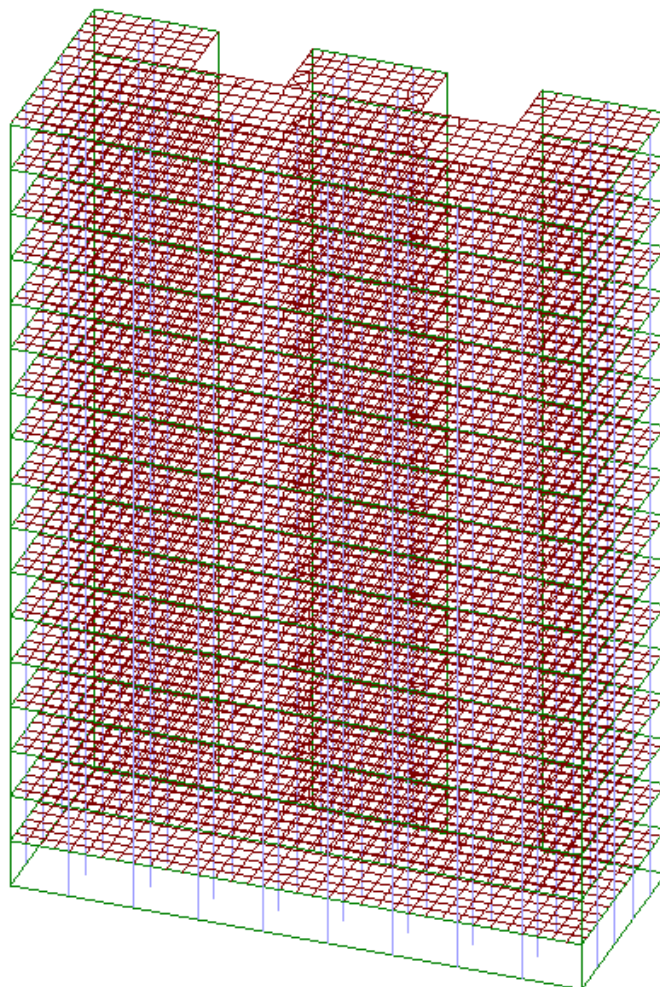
Каркас здания из деревянных элементов конструкции.
